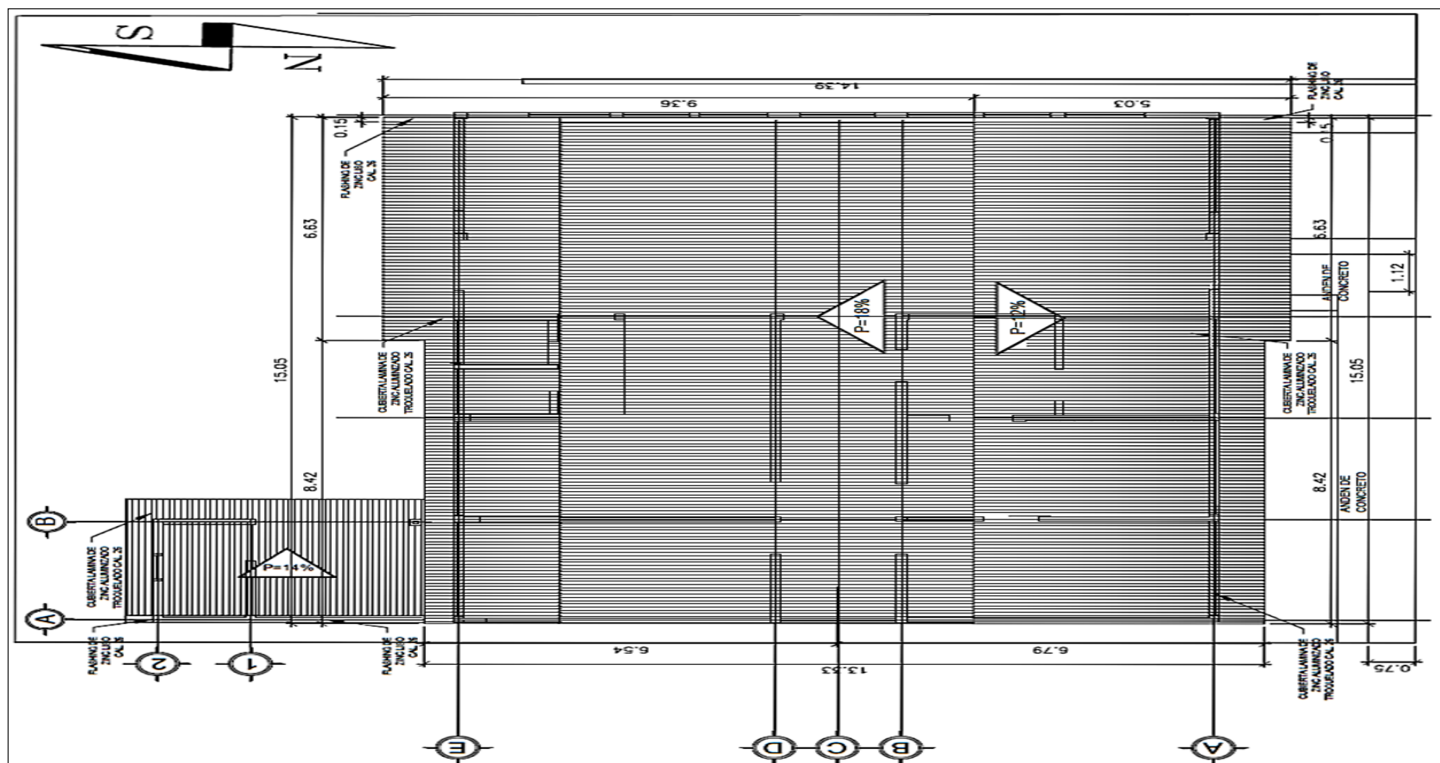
Planta Arquitectónica de techo puesto de salud Villa San Jacinto/Fuente: Elaboración propia.
